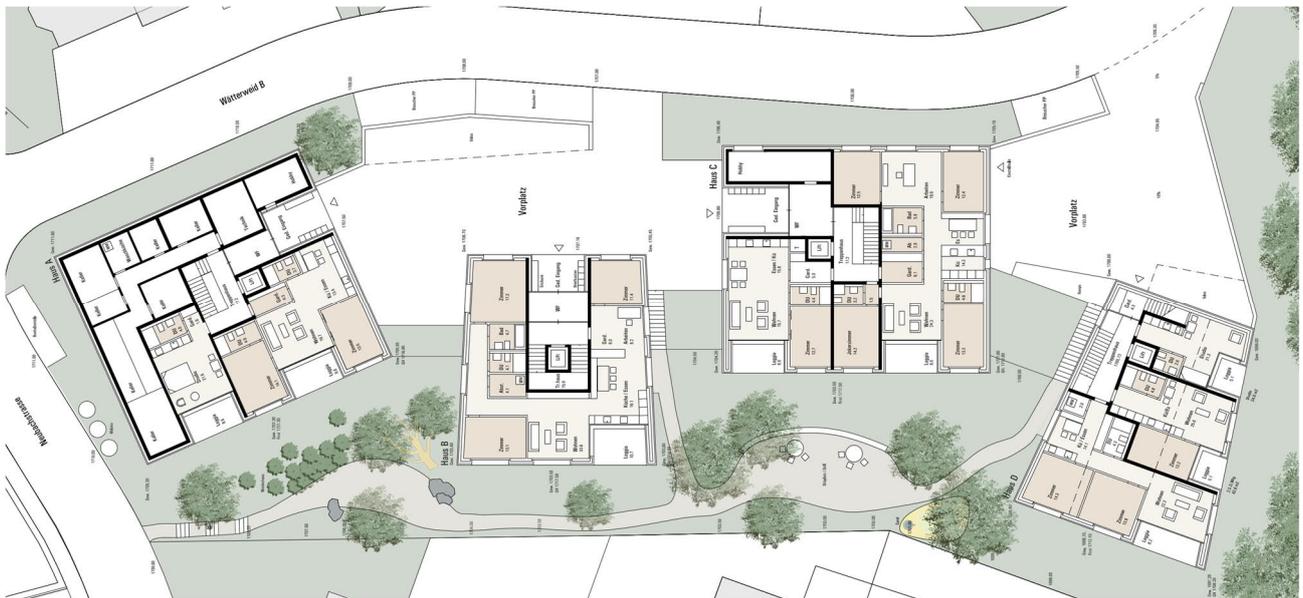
Grundriss Eingangsgeschosse z'Hengert gan (massstabslos)
